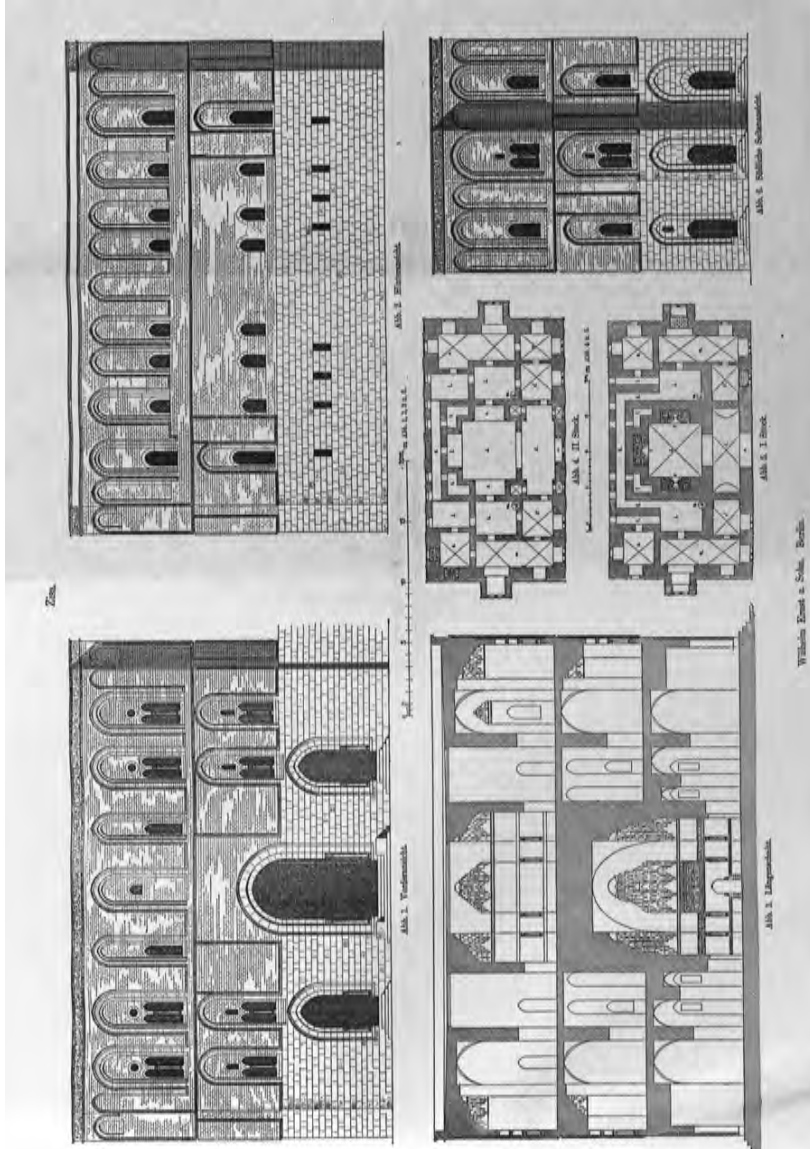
Adolph Goldschmidt, Zisa, piante, prospetti e sezione longitudinale, 1898
